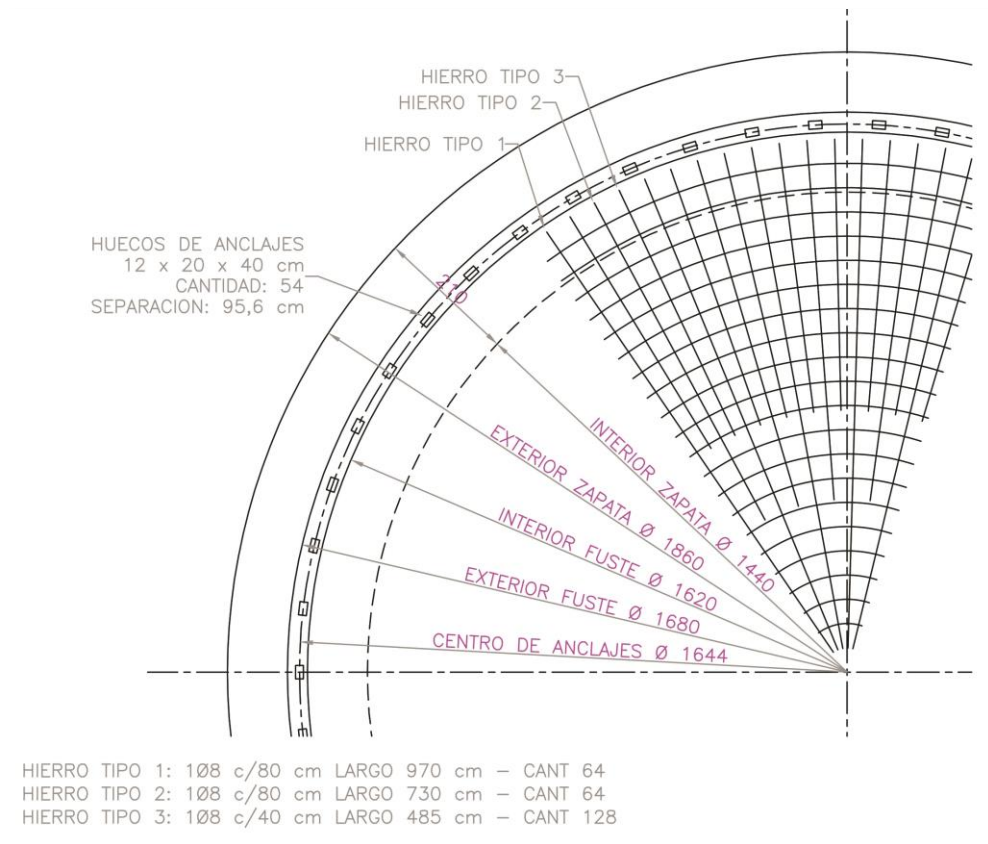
Vista en planta de fundaciones y armado de losa de fondo - Comitente
